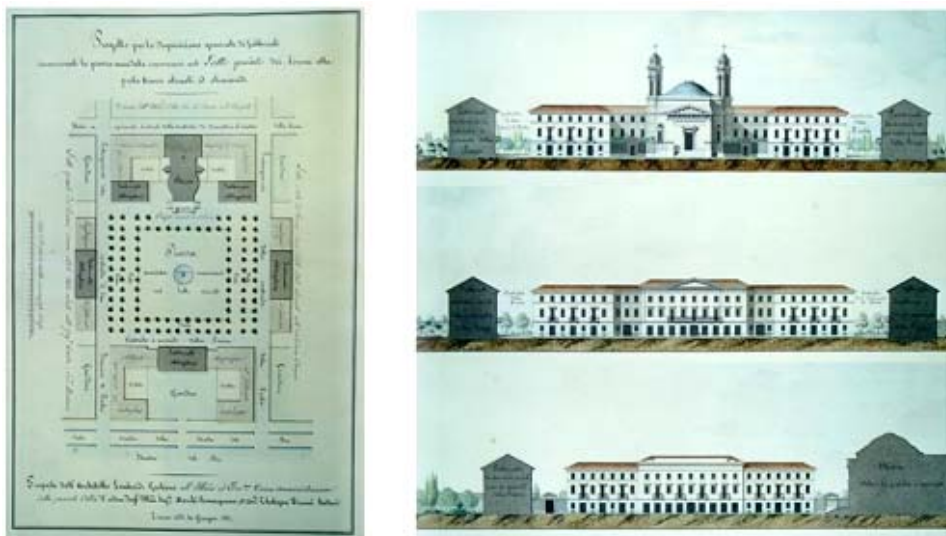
Gaetano Lombardi, progetto in pianta e prospetti per la piazza da realizzarsi nel quinto lotto.
